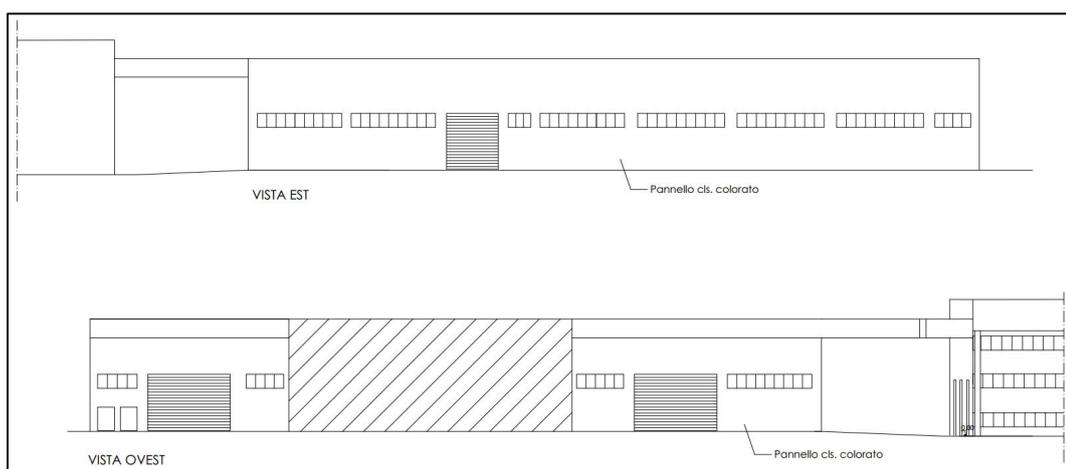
VISTA EST E OVEST DELL'INTERVENTO DEL DEPOSITO OFFICINA (C)
